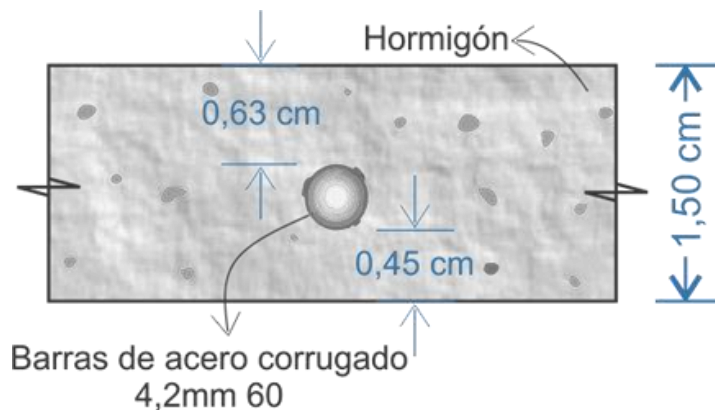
Detalle de la armadura del modelo de ventana, abierto
